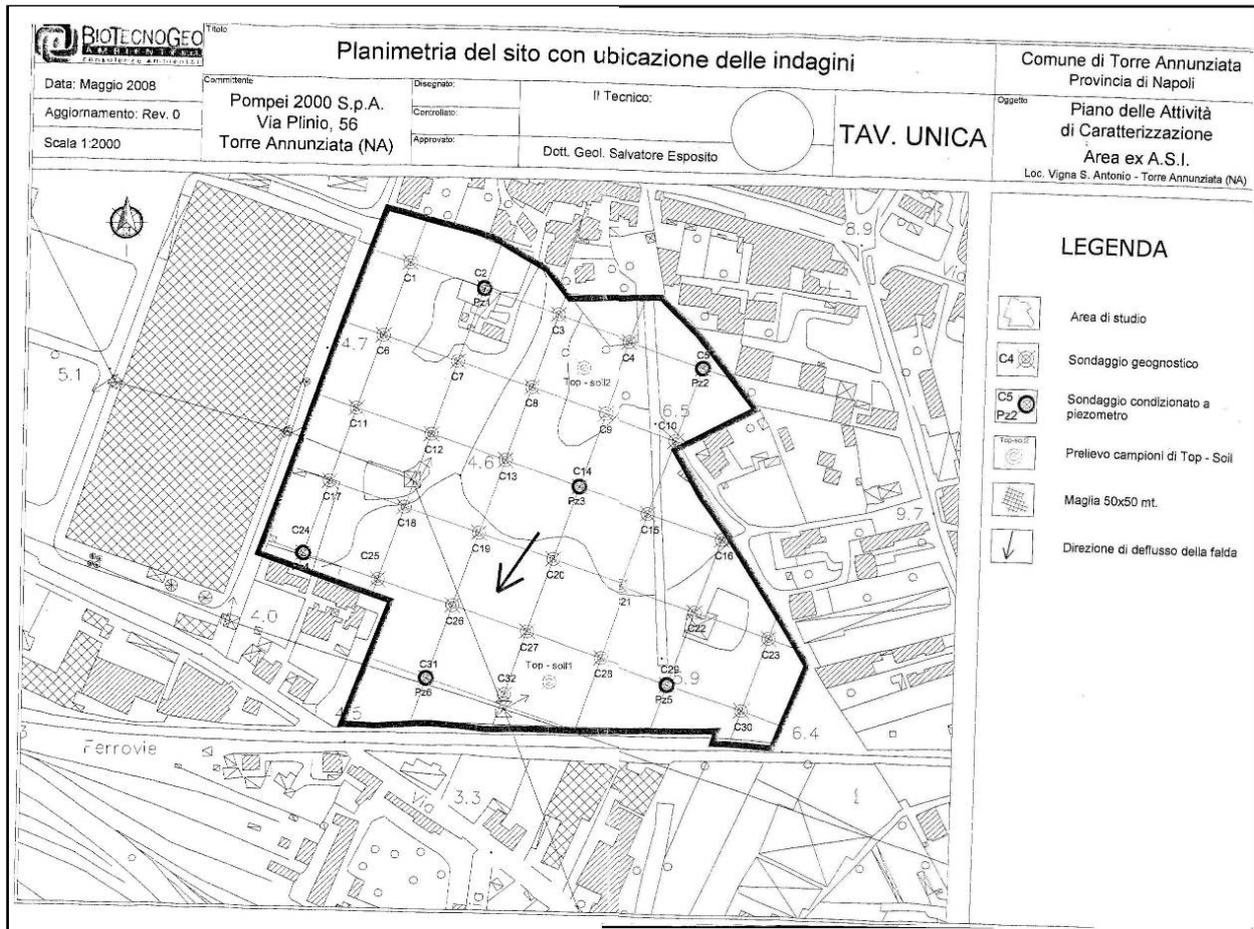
Planimetria delle attività di caratterizzazione previste
